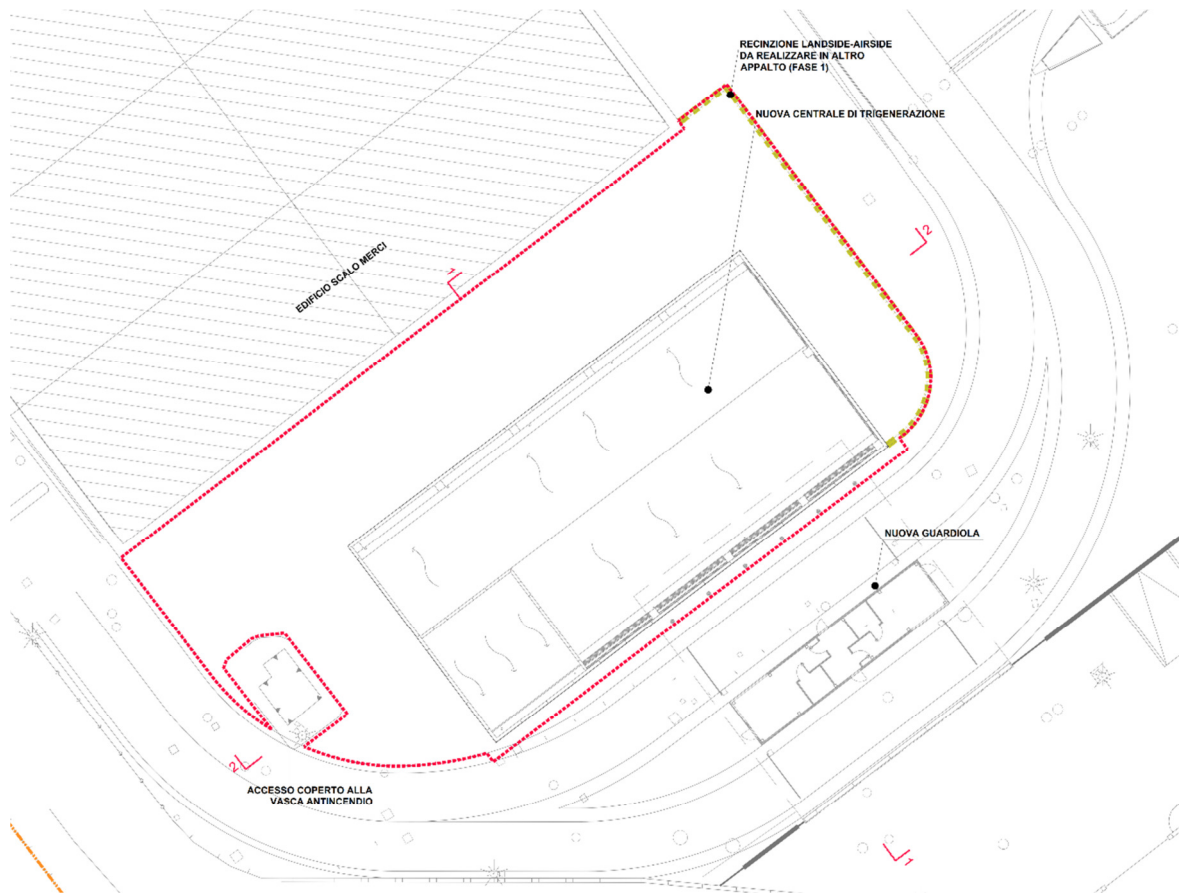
Planimetria generale di progetto con individuazione dell'area d'intervento
